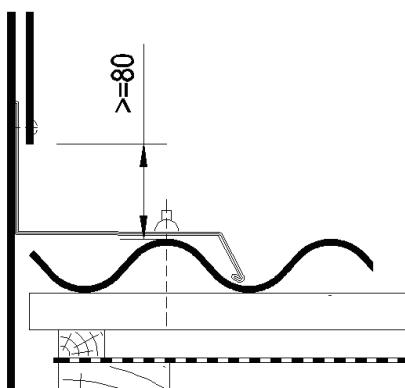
а. Жесть соединяется с фасадной конструкцией
